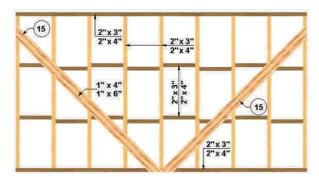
21: Muro arriostrado con tabla de madera encastrada, pieza N° 15.
